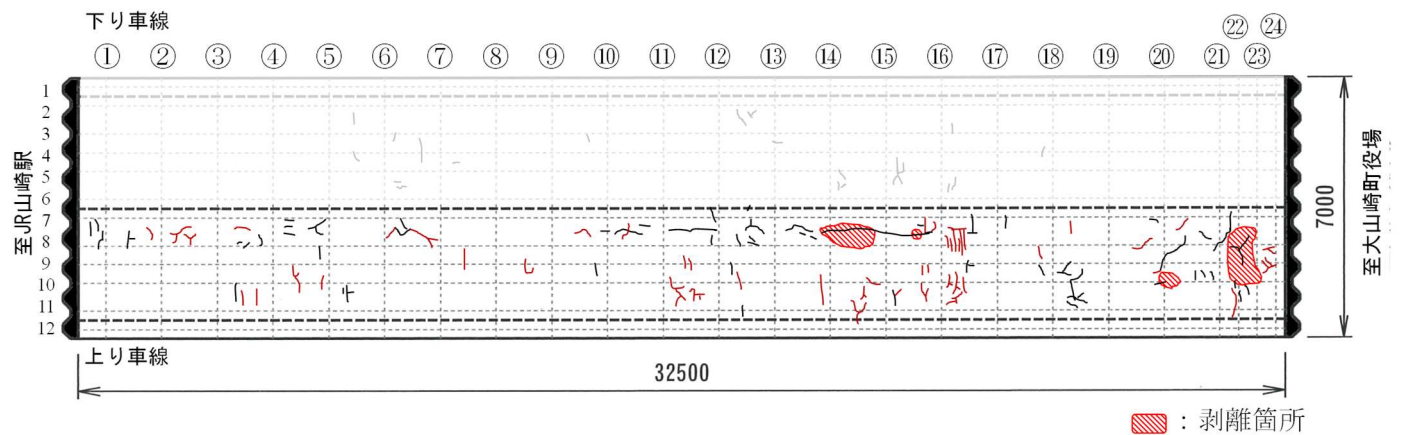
供用1.3年(冬季)ひび割れ図 (2017年12月)
